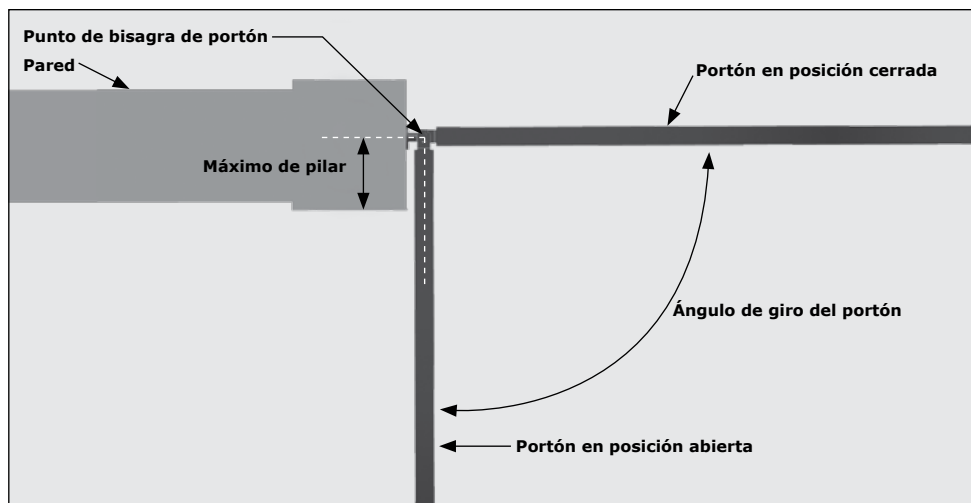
LIMITACIÓN DE PROFUNDIDAD DEL PILAR PARA PORTÓN CON APERTURA HACIA ADENTRO
